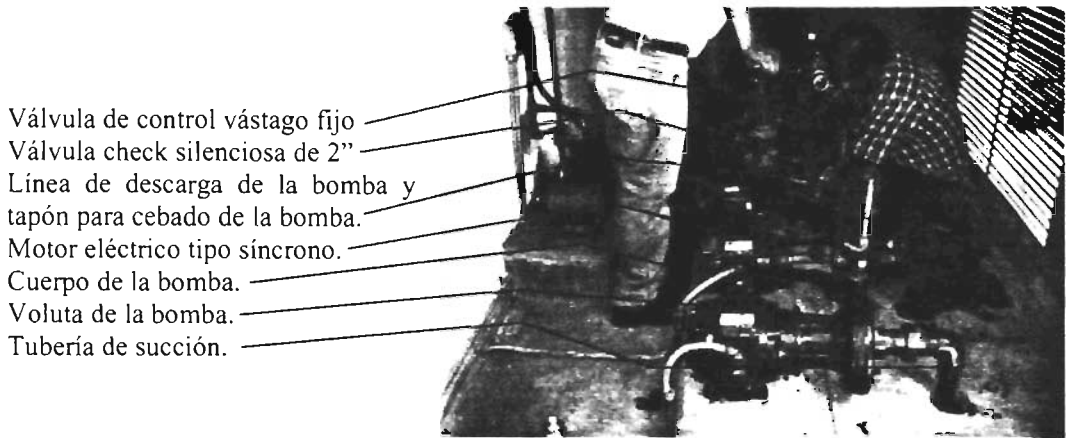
Vista interior de cuarto de hidroneumático No. 2, al momento de realizar el desmontaje de un motor, para cambio de baleros y sellos mecánicos
